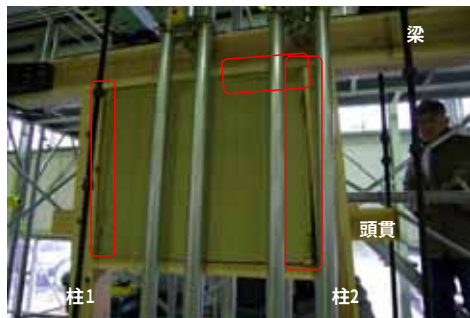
中塗側 1/20rad ひび割れの拡大
